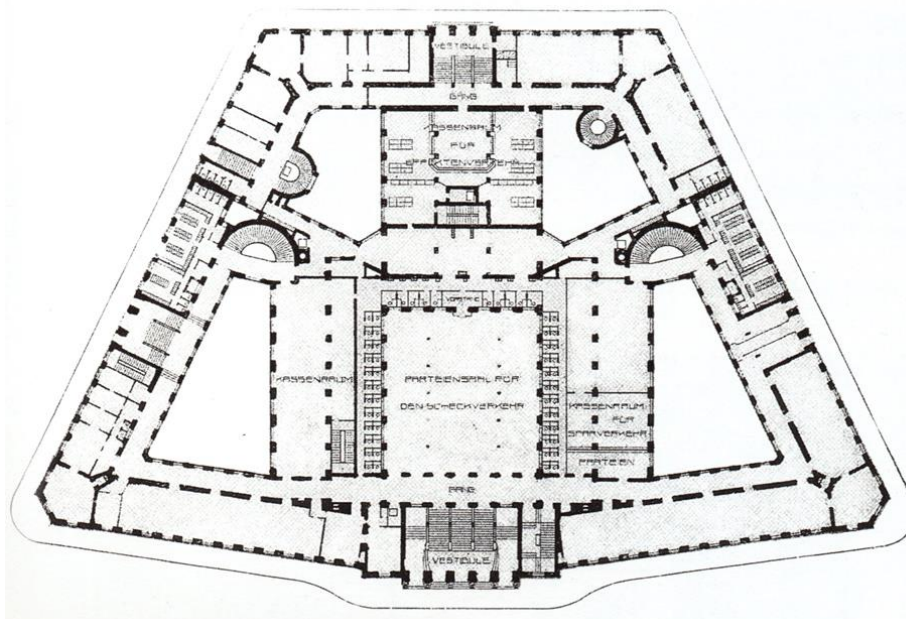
Grundriss Hochparterre, Österreichische Postsparkasse, Otto Wagner, 1906
